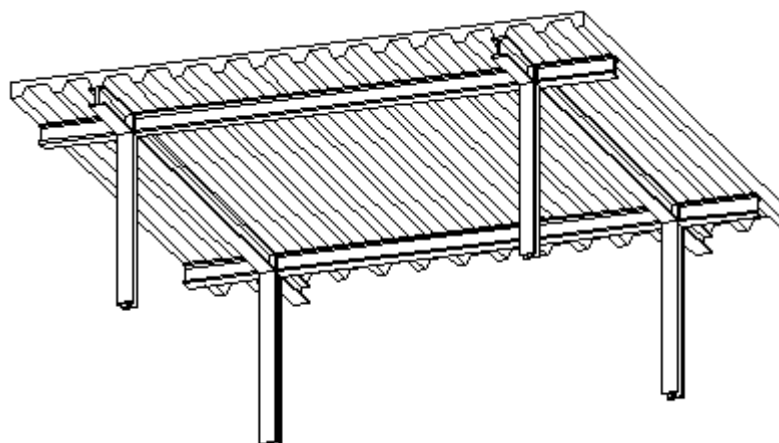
Perspectiva de um pavimento com lajes nervuradas
